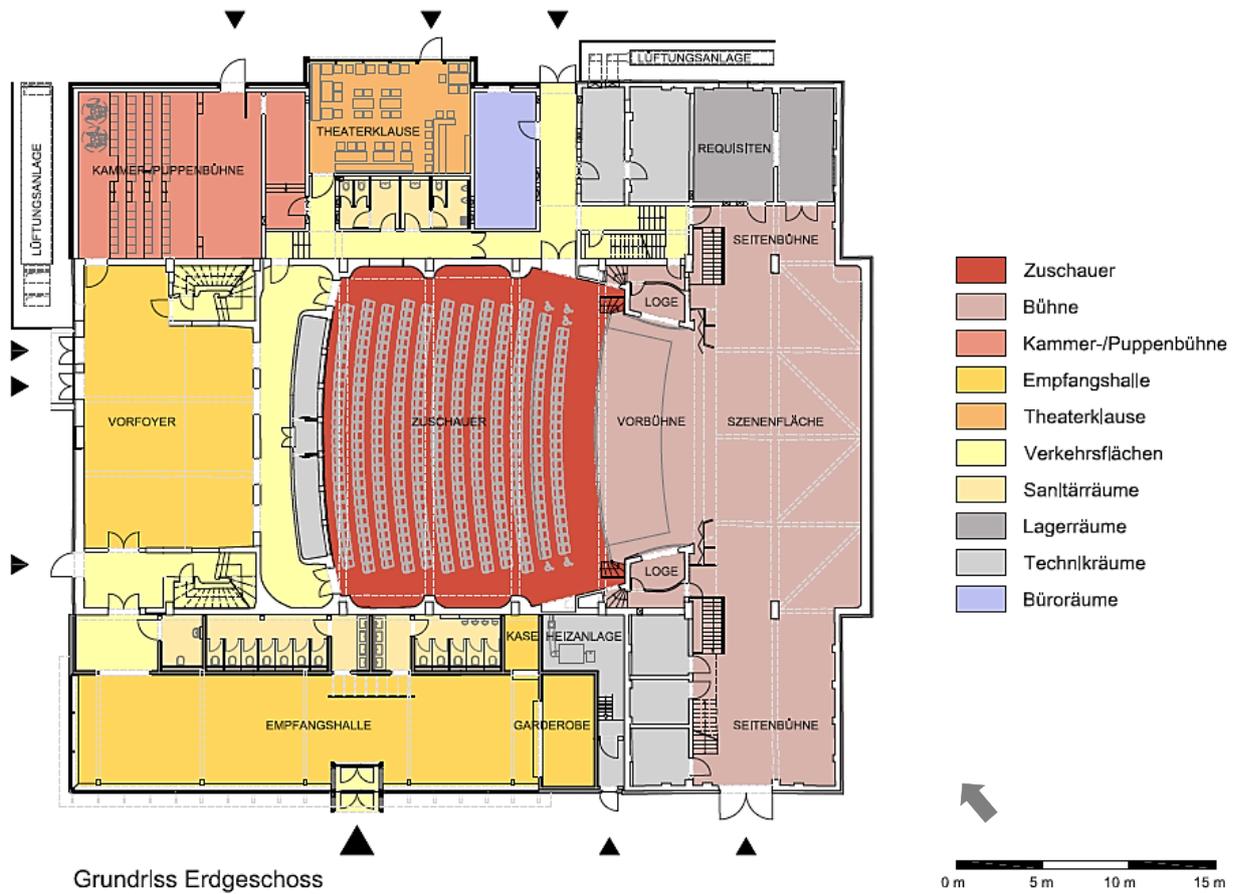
Grundriss Erdgeschoss – „Umweltgerechte Bühne Wismar“
